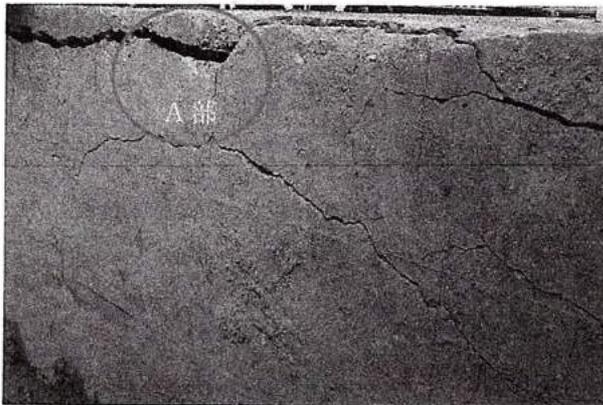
フーチング部(A部周辺)のひび割れの状況
